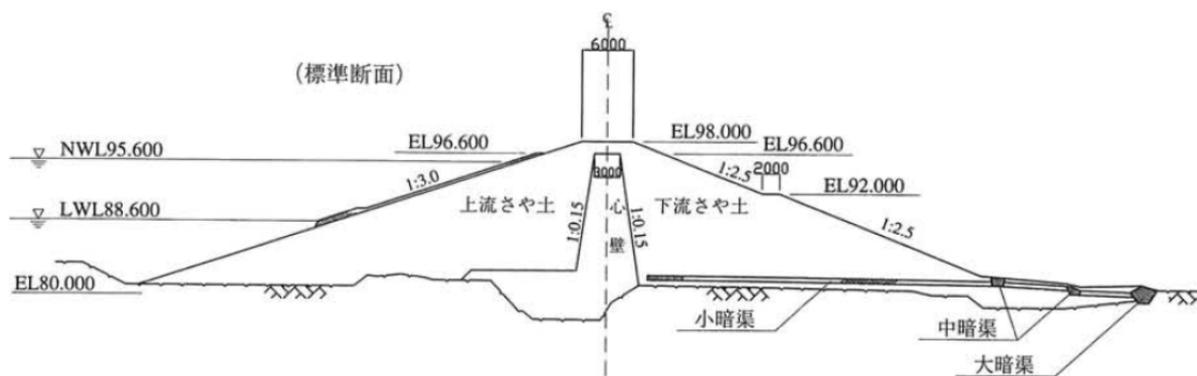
山本調整池堤体標準断面図 ⁴⁻⁹⁾
